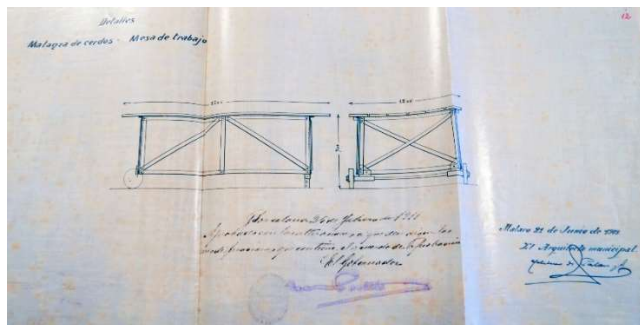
Plano del detalle de las mesas de trabajo. [12]
